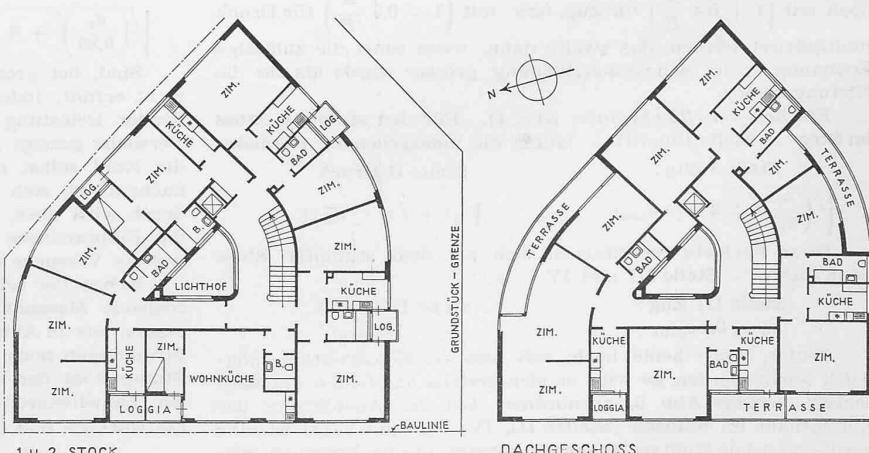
und 2. Grundrisse 1:400 des baugesetzlich unzulässigen ersten Entwurfs.
